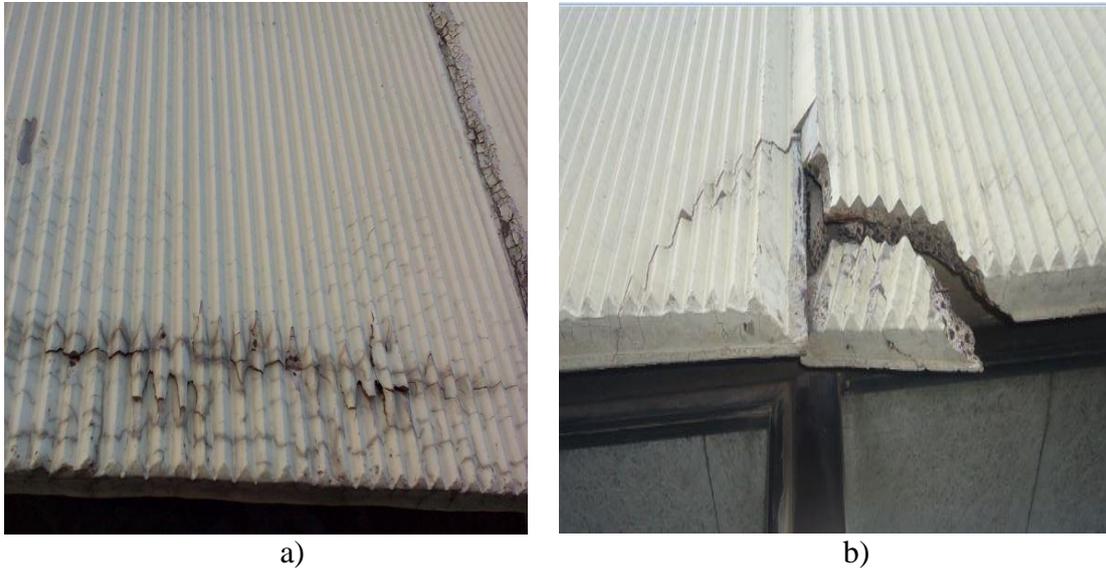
a) Empolamento do betão nos painéis pré-fabricados (Autor: H M); b) Painéis pré-fabricados quebrados (Autor: H M)
